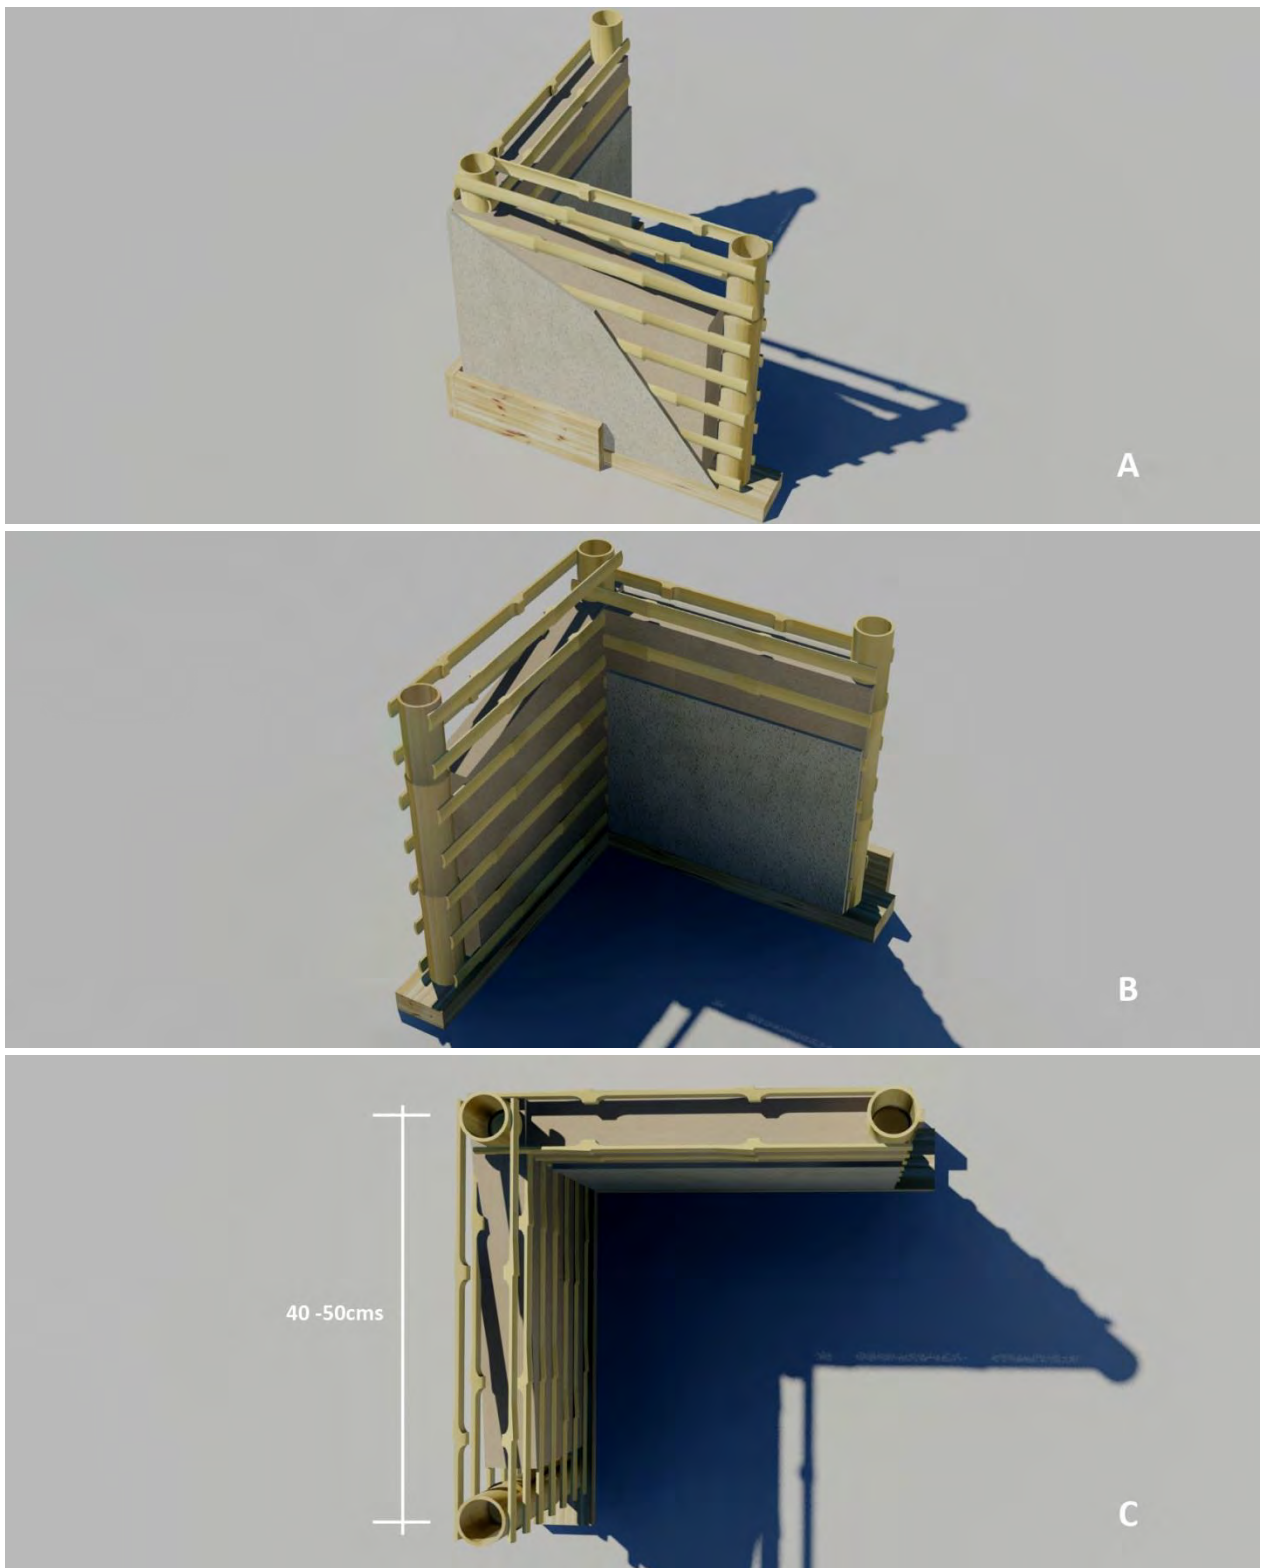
Sistema embutido: A. y B. perspectiva; C. planta (Elaborado por el autor basado en Hidalgo 2003).
